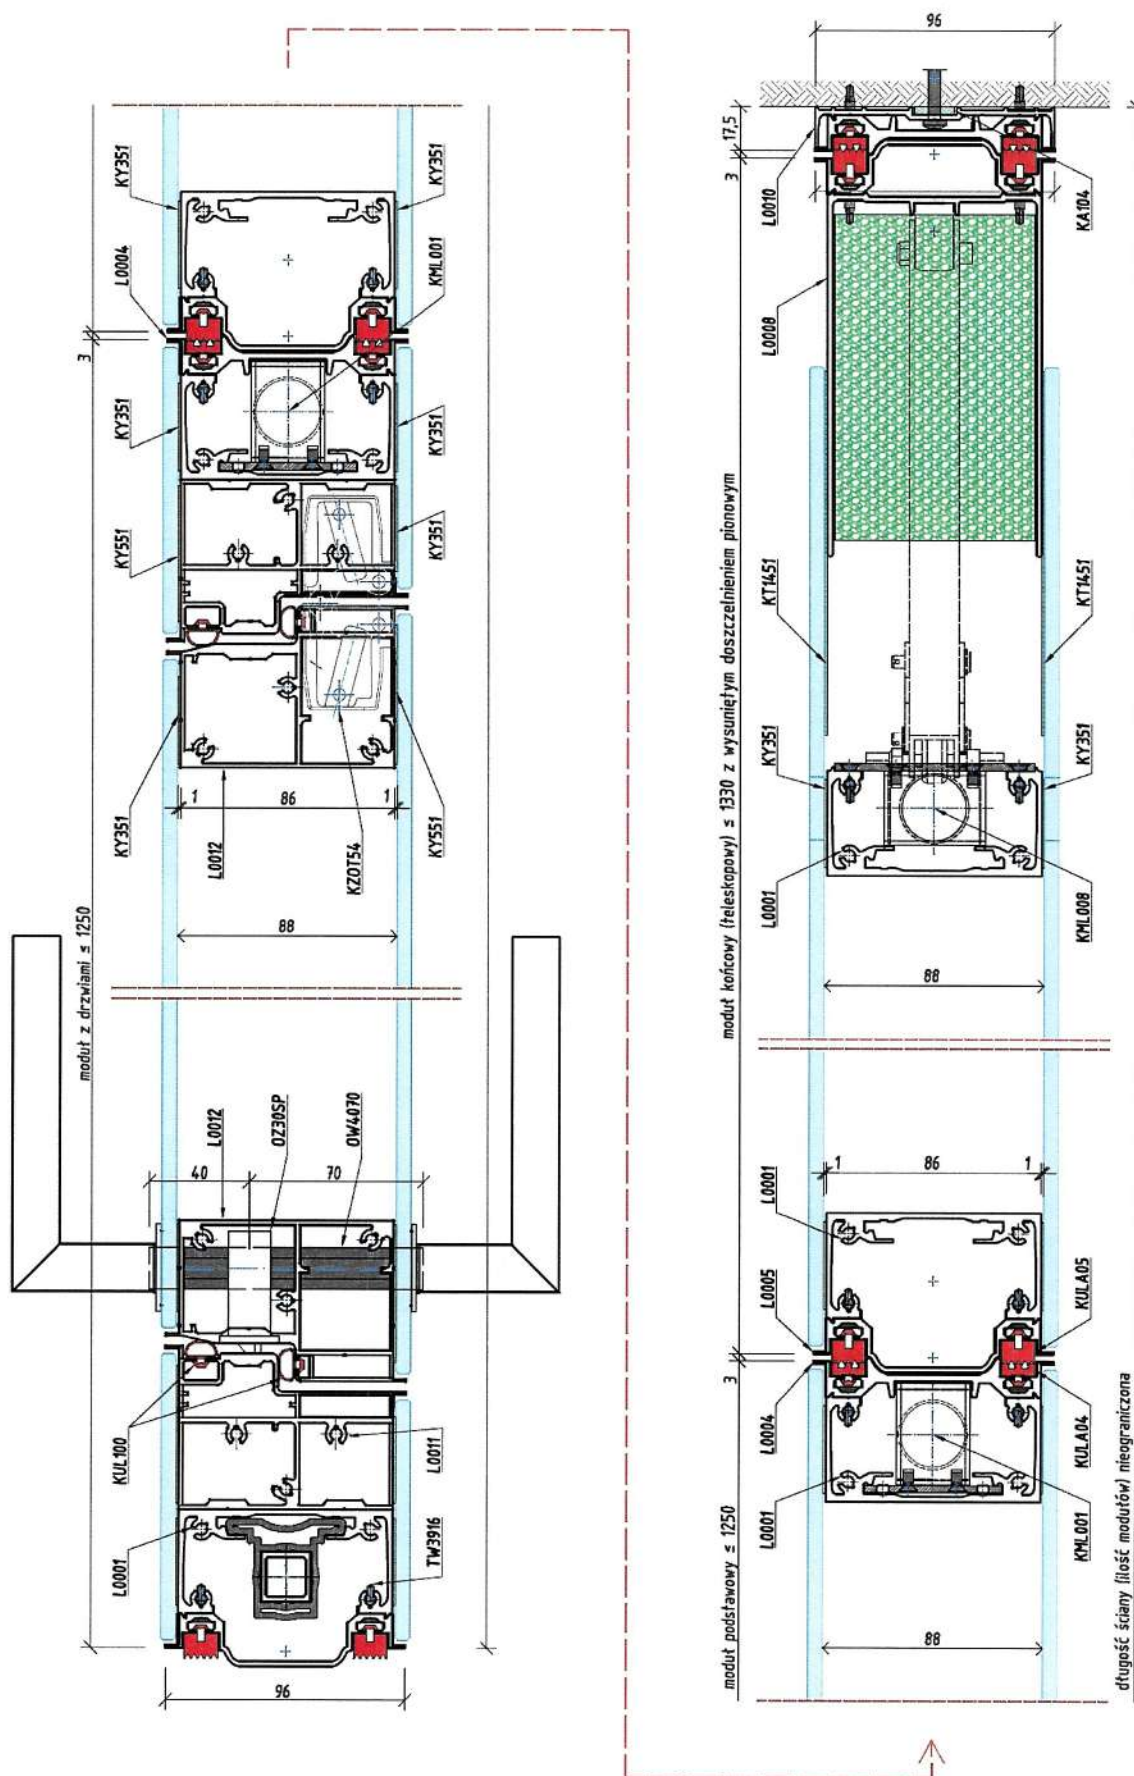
Wewnętrzna ściana przesuwna systemu ZIG ZAK – przekroje pionowe przez moduł teleskopowy
